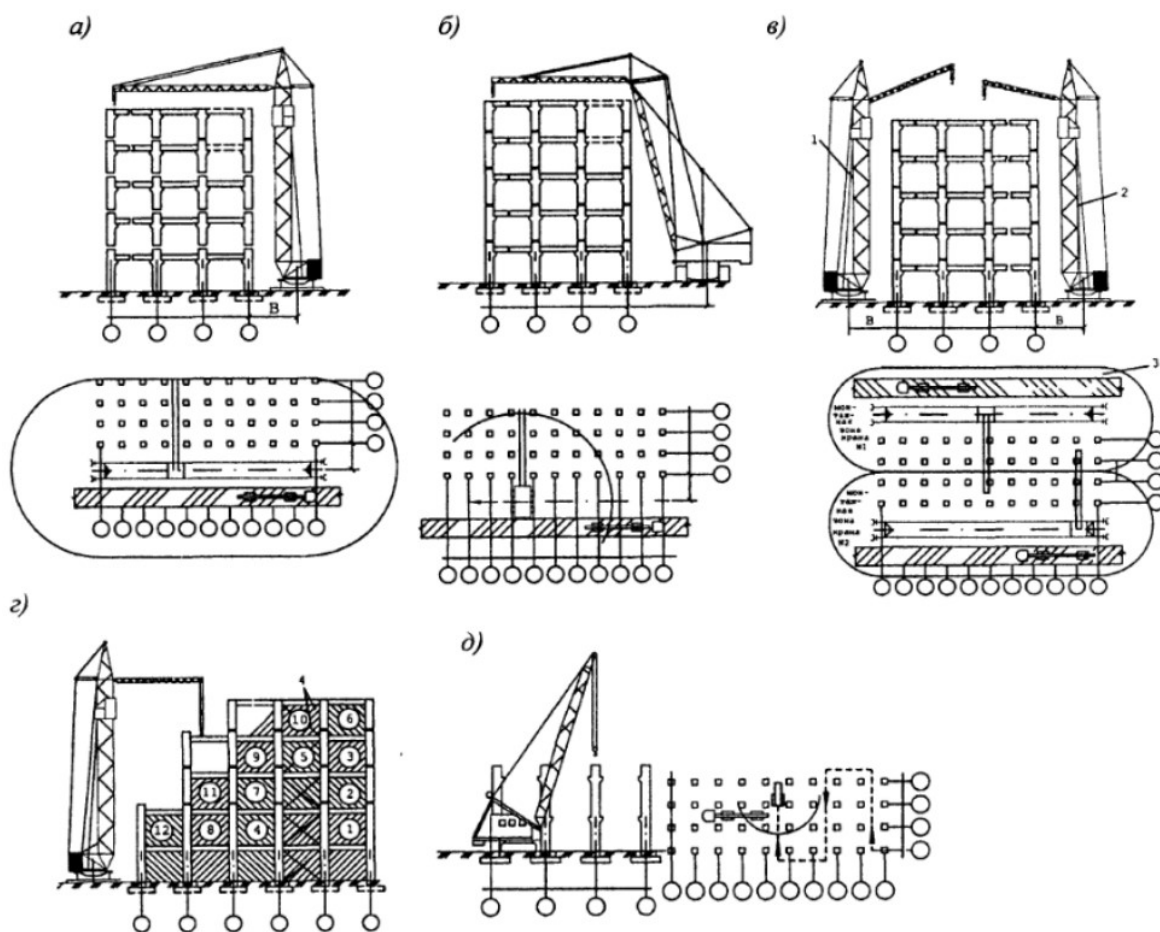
Варианты расположения монтажных кранов при возведении многоэтажных каркасно-панельных зданий: а – одностороннее расположение башенного крана; б – башенные или стреловые краны с двух сторон здания; в – одностороннее расположение башенно-стрелового крана, г – башенный или стреловой кран в пределах поперечного сечения здания; 1 и 2 - краны, 3 - монтажная зона
